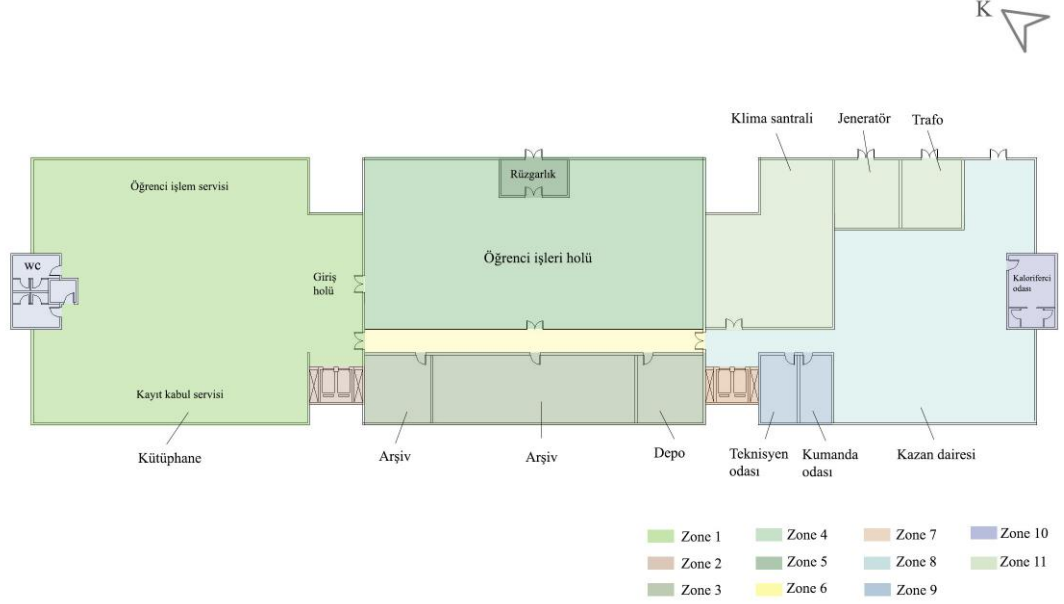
F.E.F binası 4.kat planı ve ısıl bölgeleme
